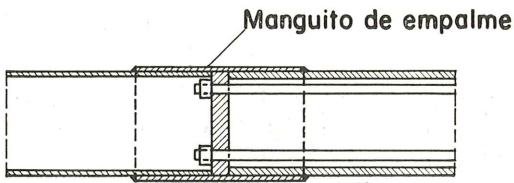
Anclaje intermedio tipo, en barras tubulares.
